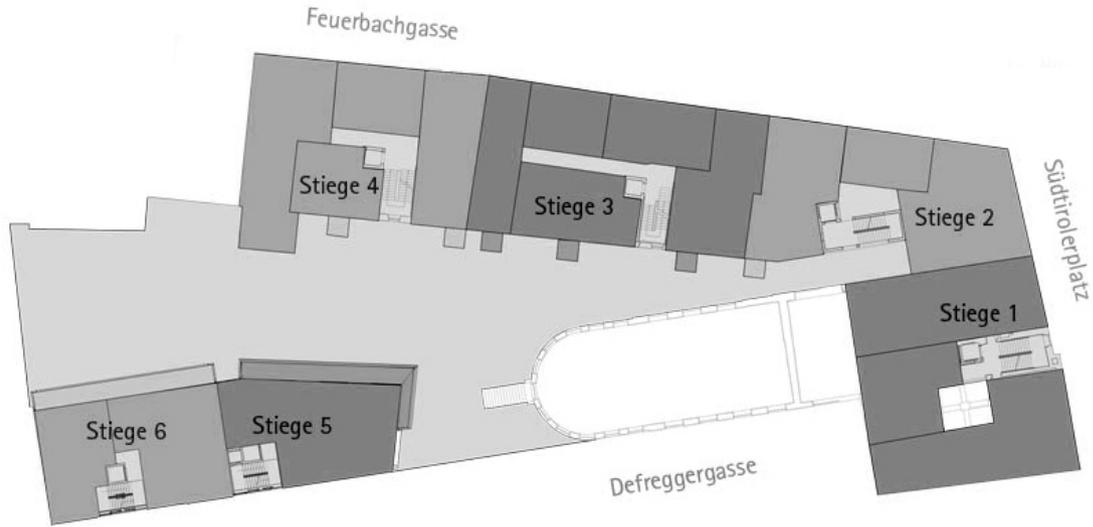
Übersichtsplan, © Domenig&Wallner ZT
